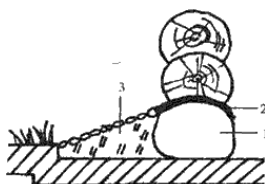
Фундамент из природного камня: 1 – камень; 2 – гидроизоляция; 3 – глиняная отмостка.
